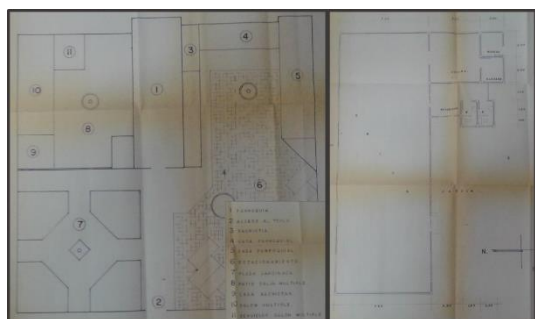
Planos de anexos a la parroquia. (INAH, 2018)
